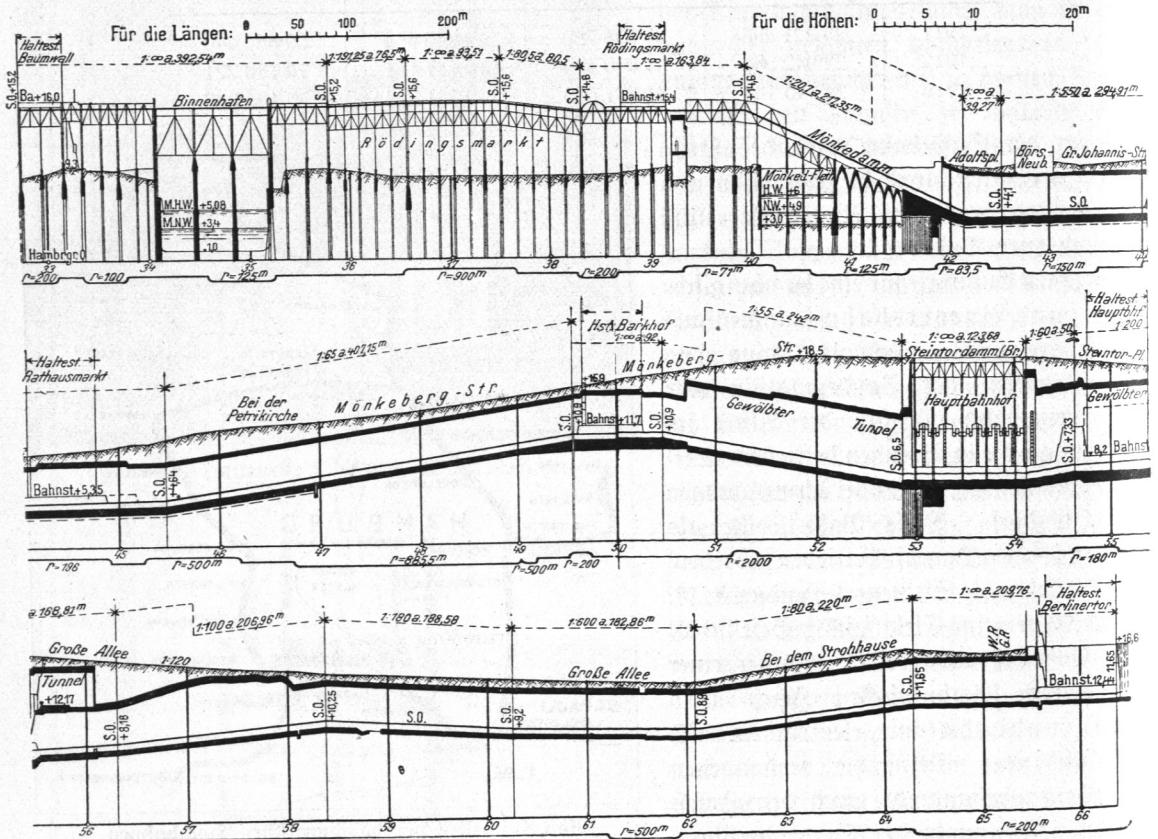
Längsschnitt der Strecke Baumwall—Berliner Tor.
